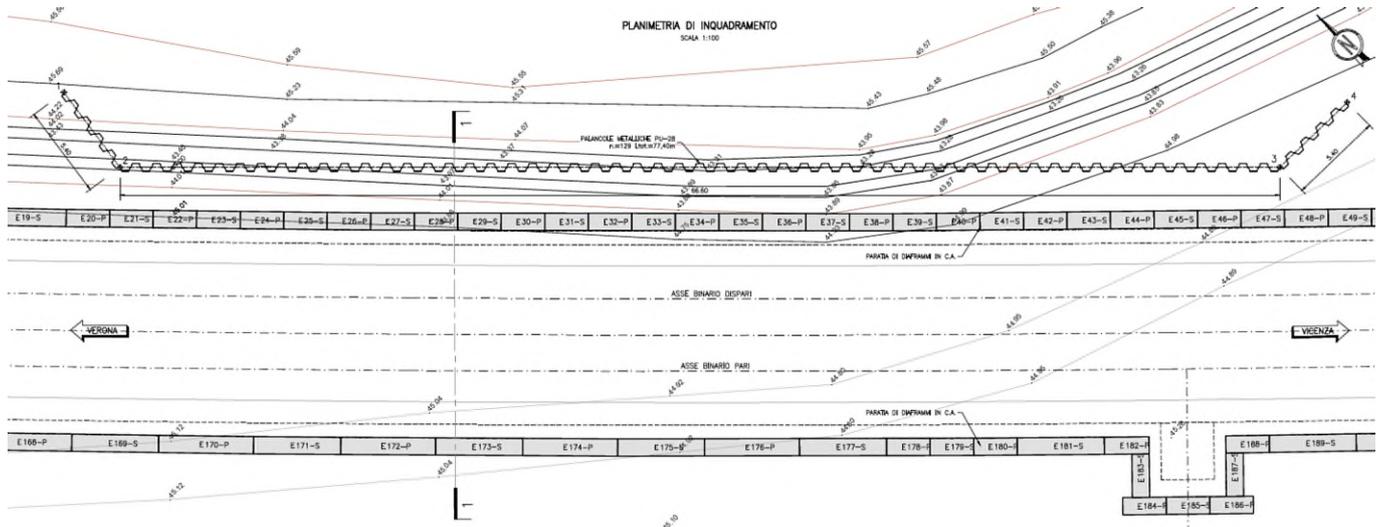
Planimetria di inquadramento – Opera Provvisoriale E
